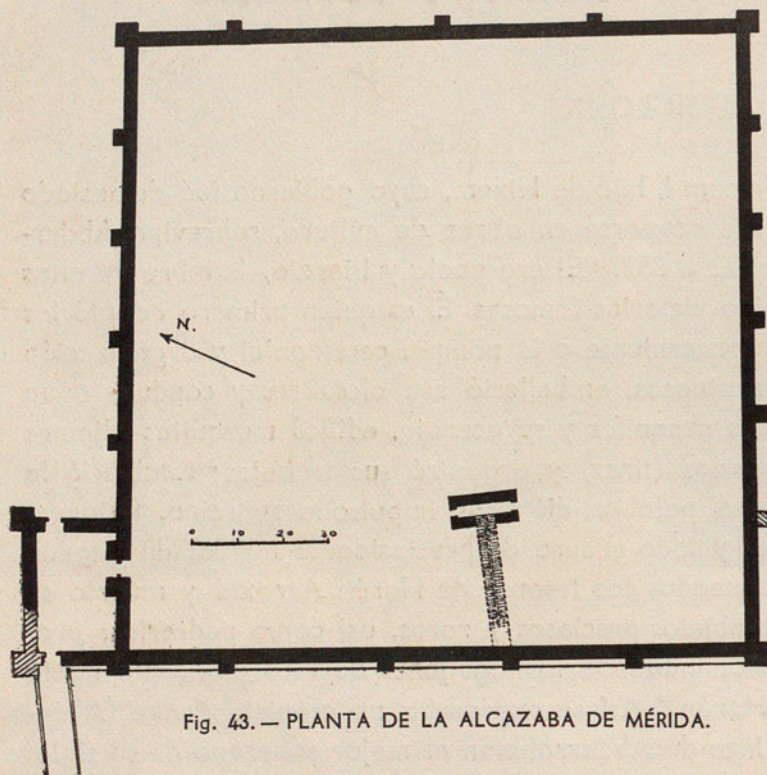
PLANTA DE LA ALCAZABA DE MÉRIDA.
